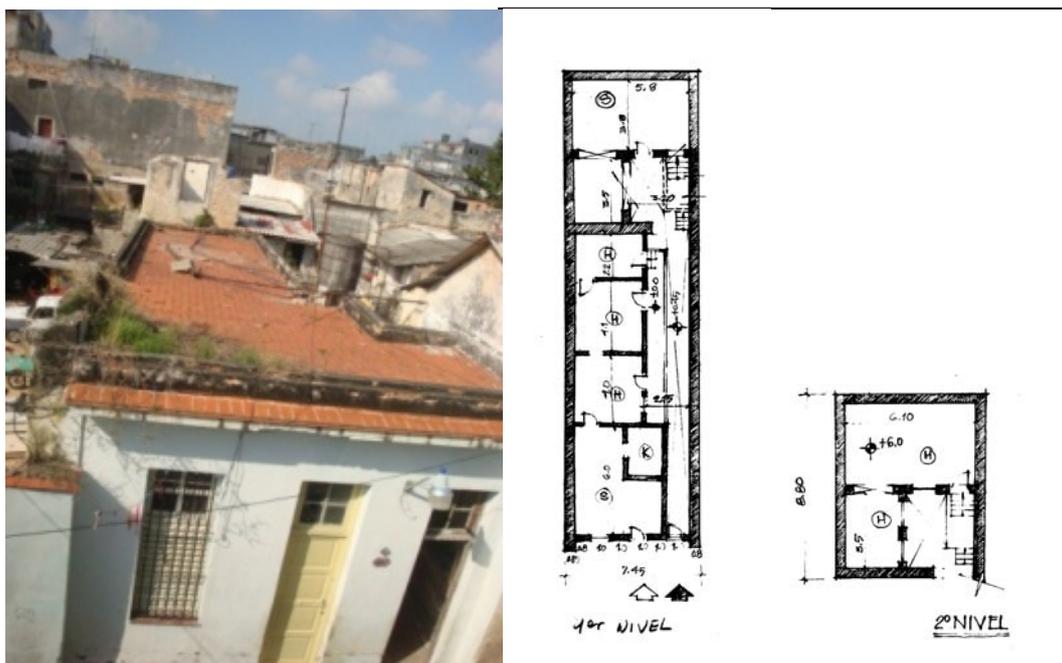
, y 58. Plantas y vista del estado de deterioro de la cubierta del inmueble.
